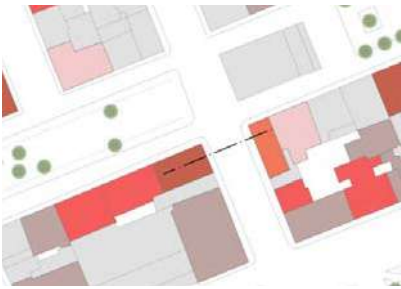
Planimetria di inquadramento della sezione sull'asse urbano esistente
